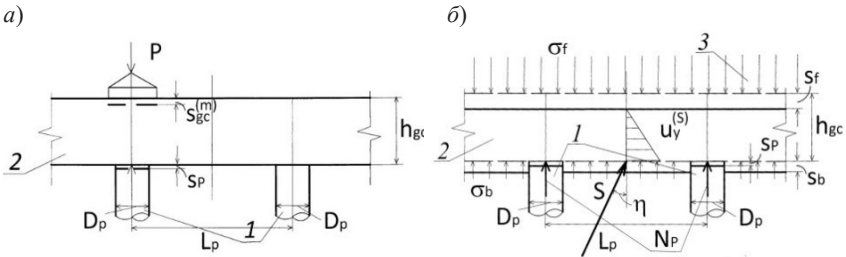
Схемы испытания промежуточного распределительного слоя (а) и нагружения его фундаментной плитой (б): 1 – сваи; 2 – промежуточный распределительный слой; 3 – нагрузка от здания
